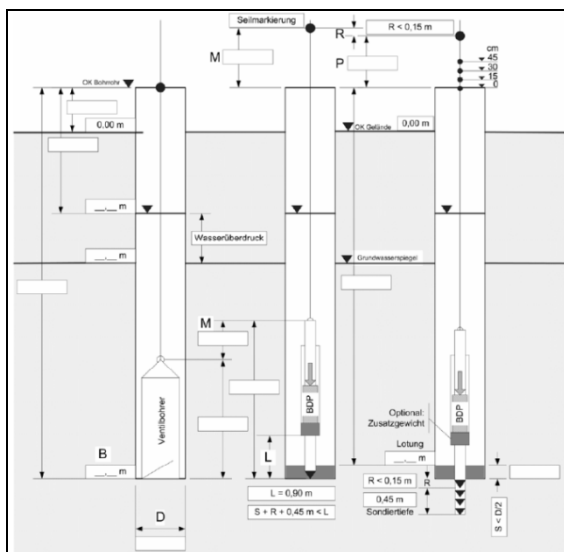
Durchführung einer Bohrlochrammsondierung (BDP)
